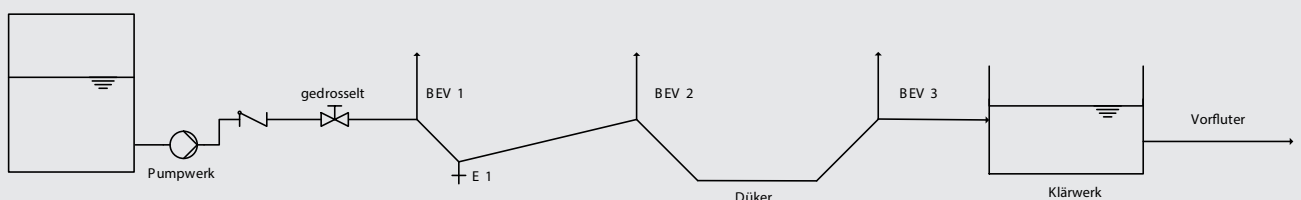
Schema einer Abwasserdruckleitung mit BEV vor und nach Düker
